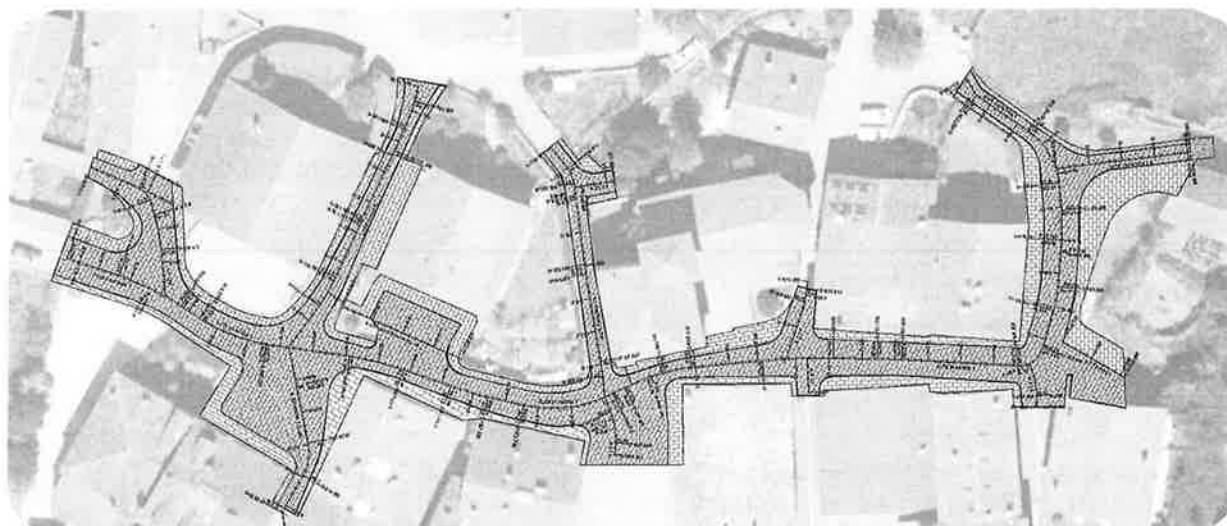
Planta de renovación de pavimentación diseñada para c/Alde Zaharra nº14-nº22
